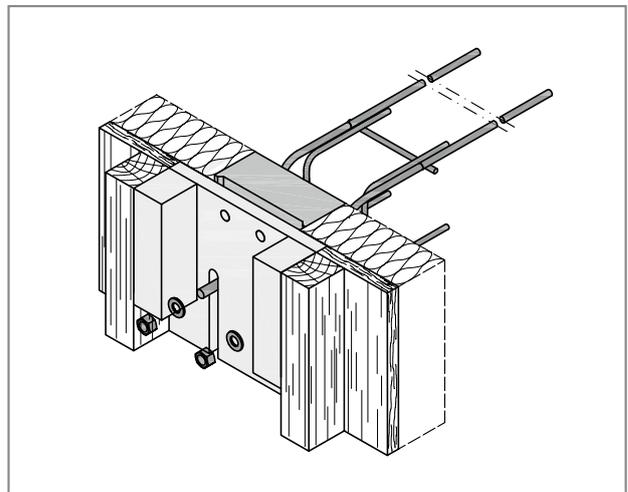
Schöck Isokorb® T type SQ : aide au montage inversée pour permettre une isolation parfaite des bords de la dalle en cas de mur monolithique
